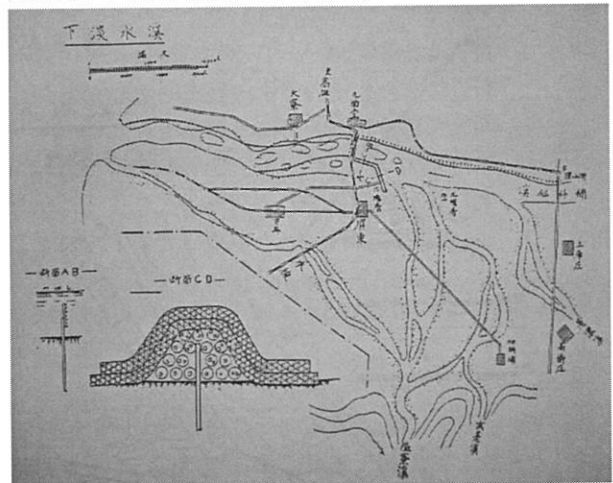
下淡水溪災害復旧工事平面図と鉄筋コンクリート杭、蛇籠堤設計略図(『顧台』、1936)
